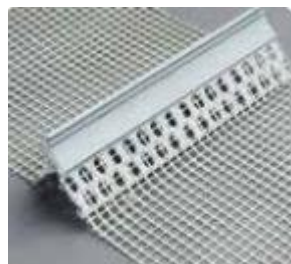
Perfil perfurado em PVC com rede para pingadeira em janelas e portas (Saint-Gobain, 2016)
